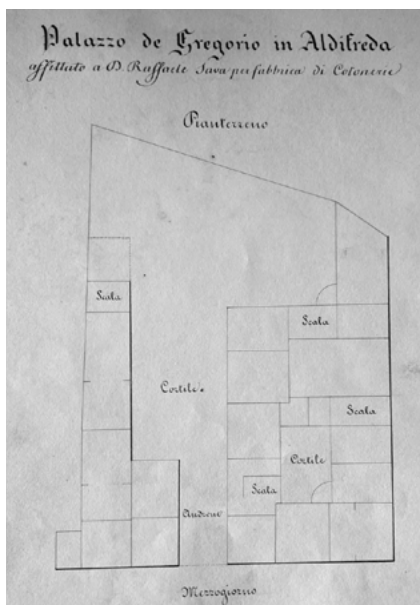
Palazzo de Gregorio in Aldifreda affittato a d. Raffaele Sava per fabbrica di cotonerie, Piantterreno, a destra, Primo piano, Secondo Piano, disegni. Archivio Storico della Reggia di Caserta, Planimetrie, 3561, Planimetrie di possedimenti della Reale Amministrazione di Caserta nelle sue adiacenze, nn. 13-14.
